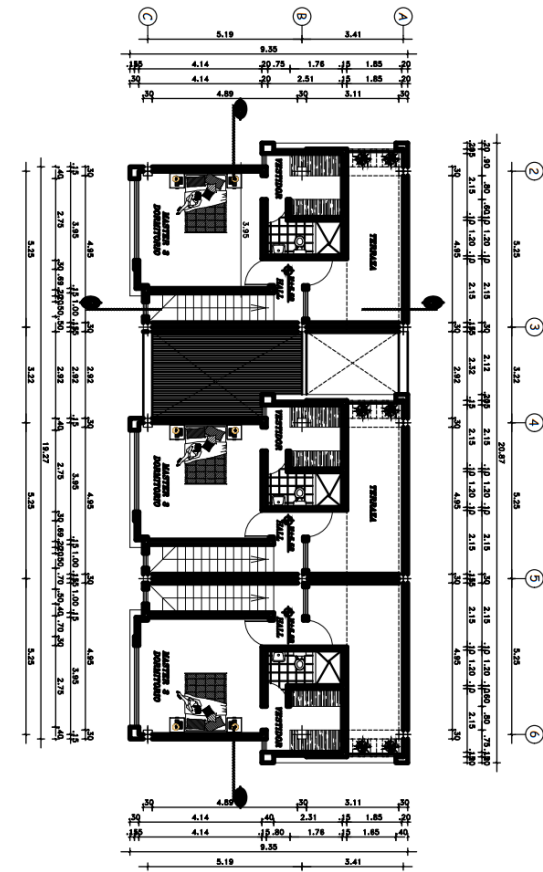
PLANO ARQUITECTÓNICO PLANTA ALTA 2
